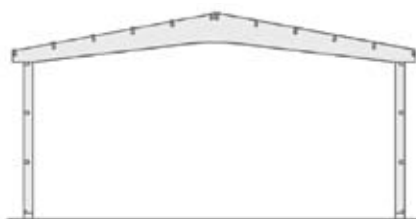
Dźwigar prosty o zmiennym przekroju (typu „dwutrapez”), tworzący dach dwuspadowy przy zachowaniu poziomej dolnej krawędzi konstrukcji. Maksymalny spadek połączy ~5 stopni. Rozpiętości nawet do ponad 50 m.
